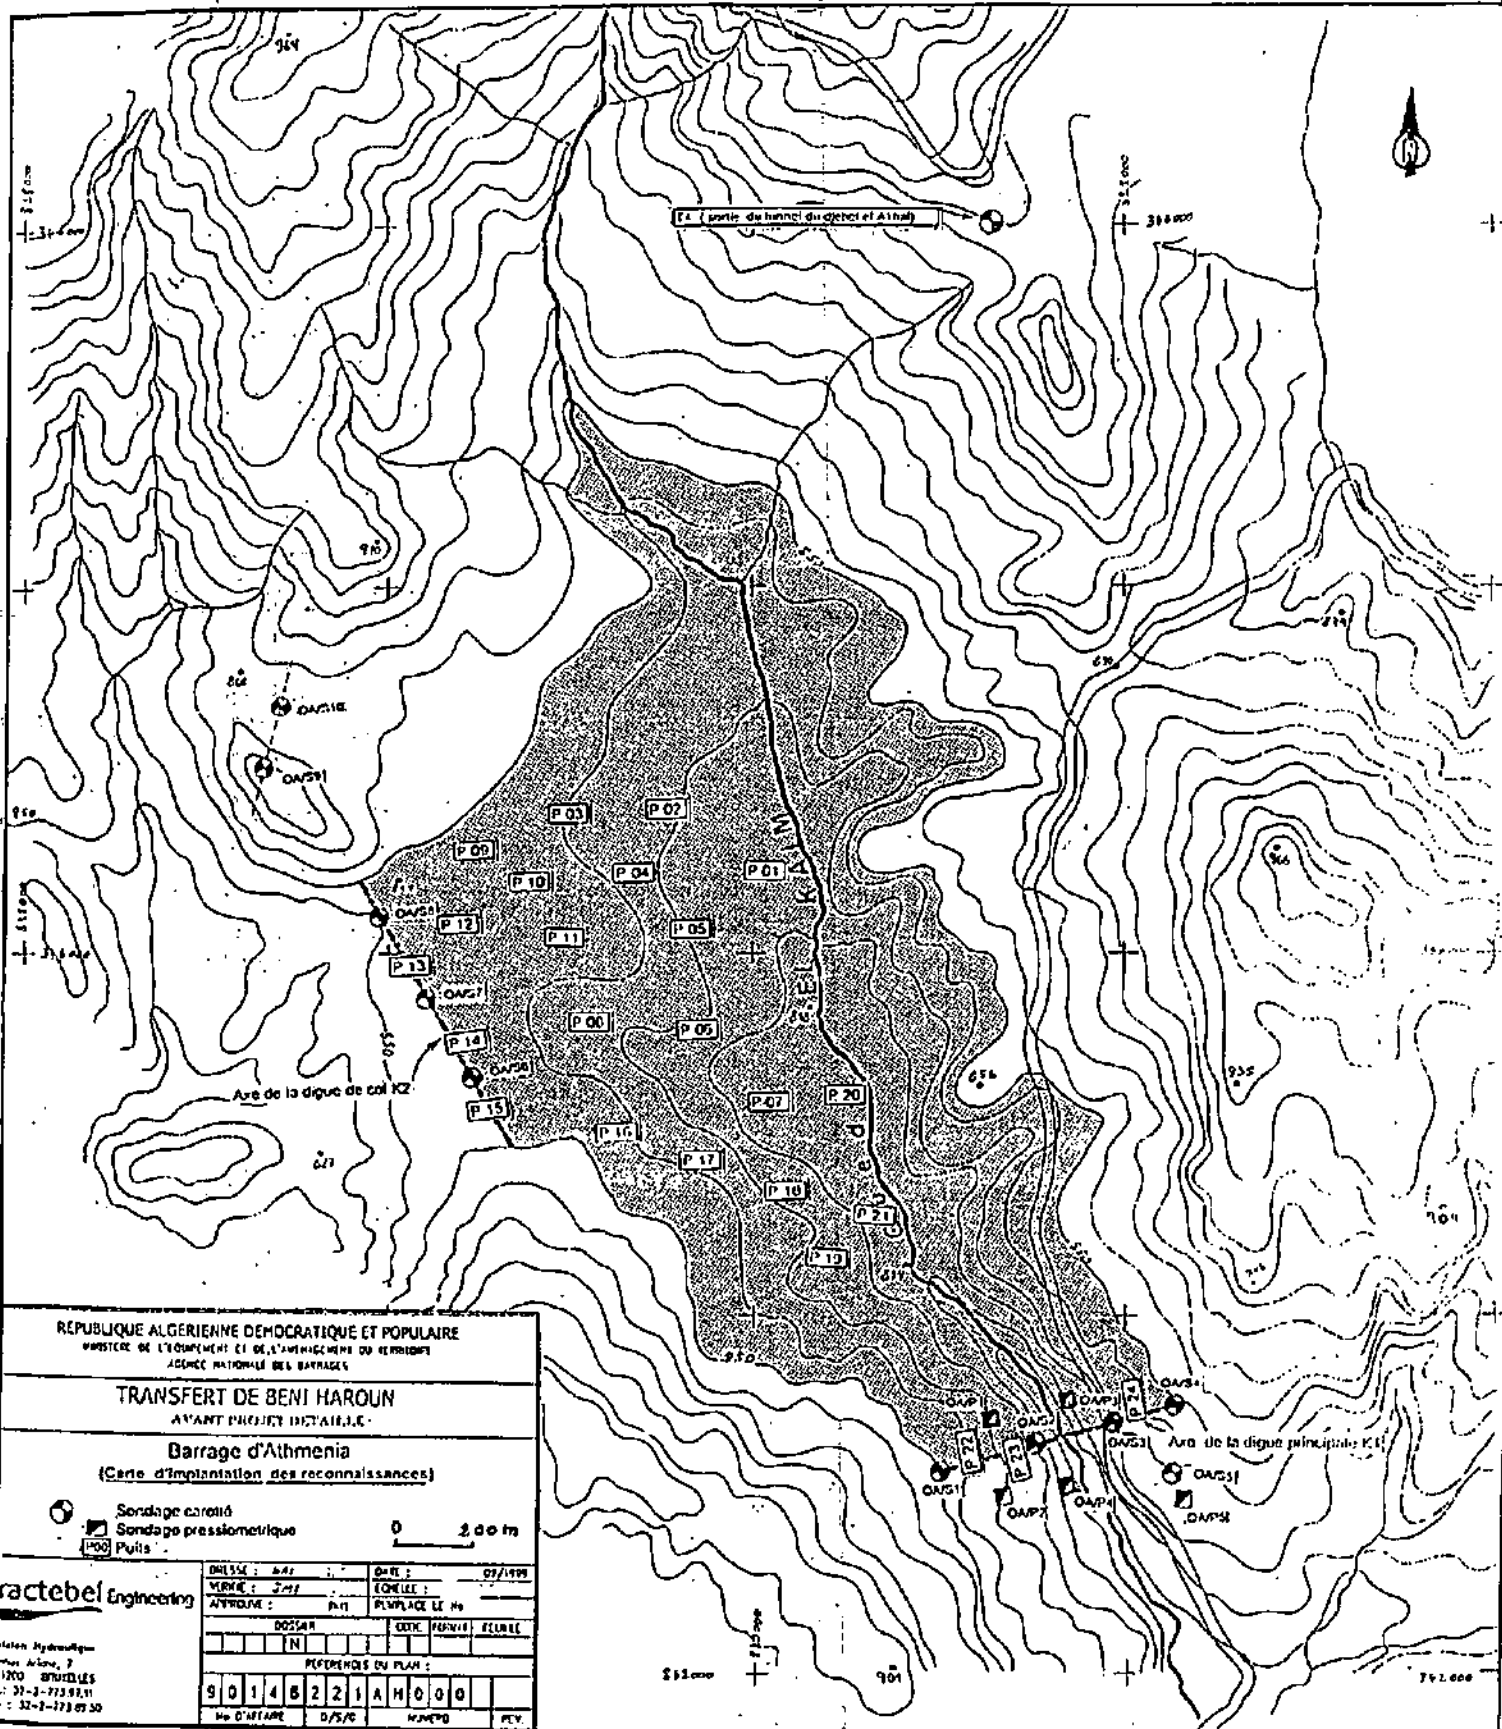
Plan d'implantation des essais in situ (barrage Oued El Kaïm).
